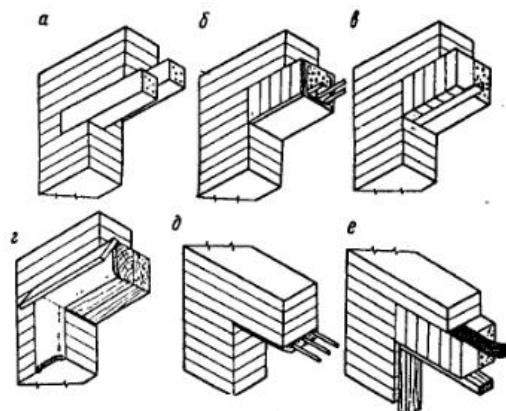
Перемычки: а — железобетонная сборная; б — железобетонная монолитная с облицовочной керамической плиткой; в — кирпичные по металлическому уголку; г — деревянная брусковая; д — из стальных арматурных стержней; е — кирпичная с арматурной сеткой.
